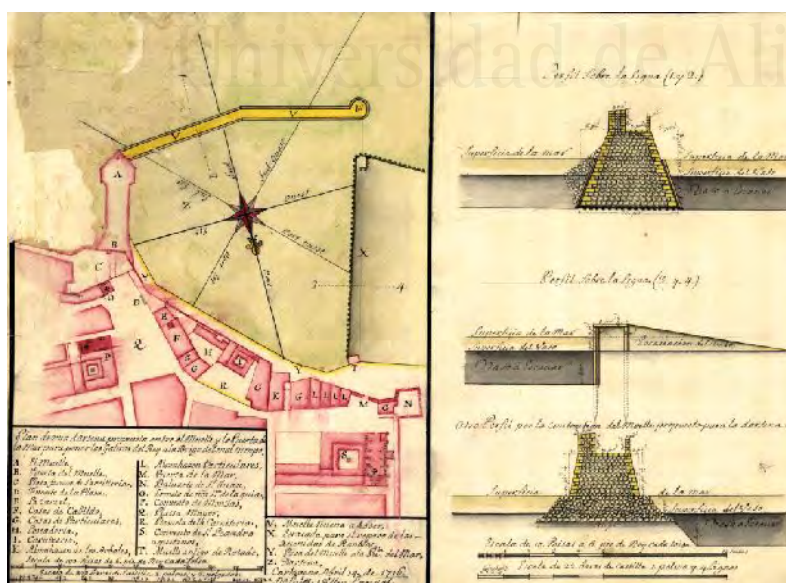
Plan de una dársena propuesta entre el Muelle y la Puerta de la Mar para poner las Galeras del Rey al abrigo del mal tiempo. 1716. Viller Langot. (SGE MP RM, 40)
